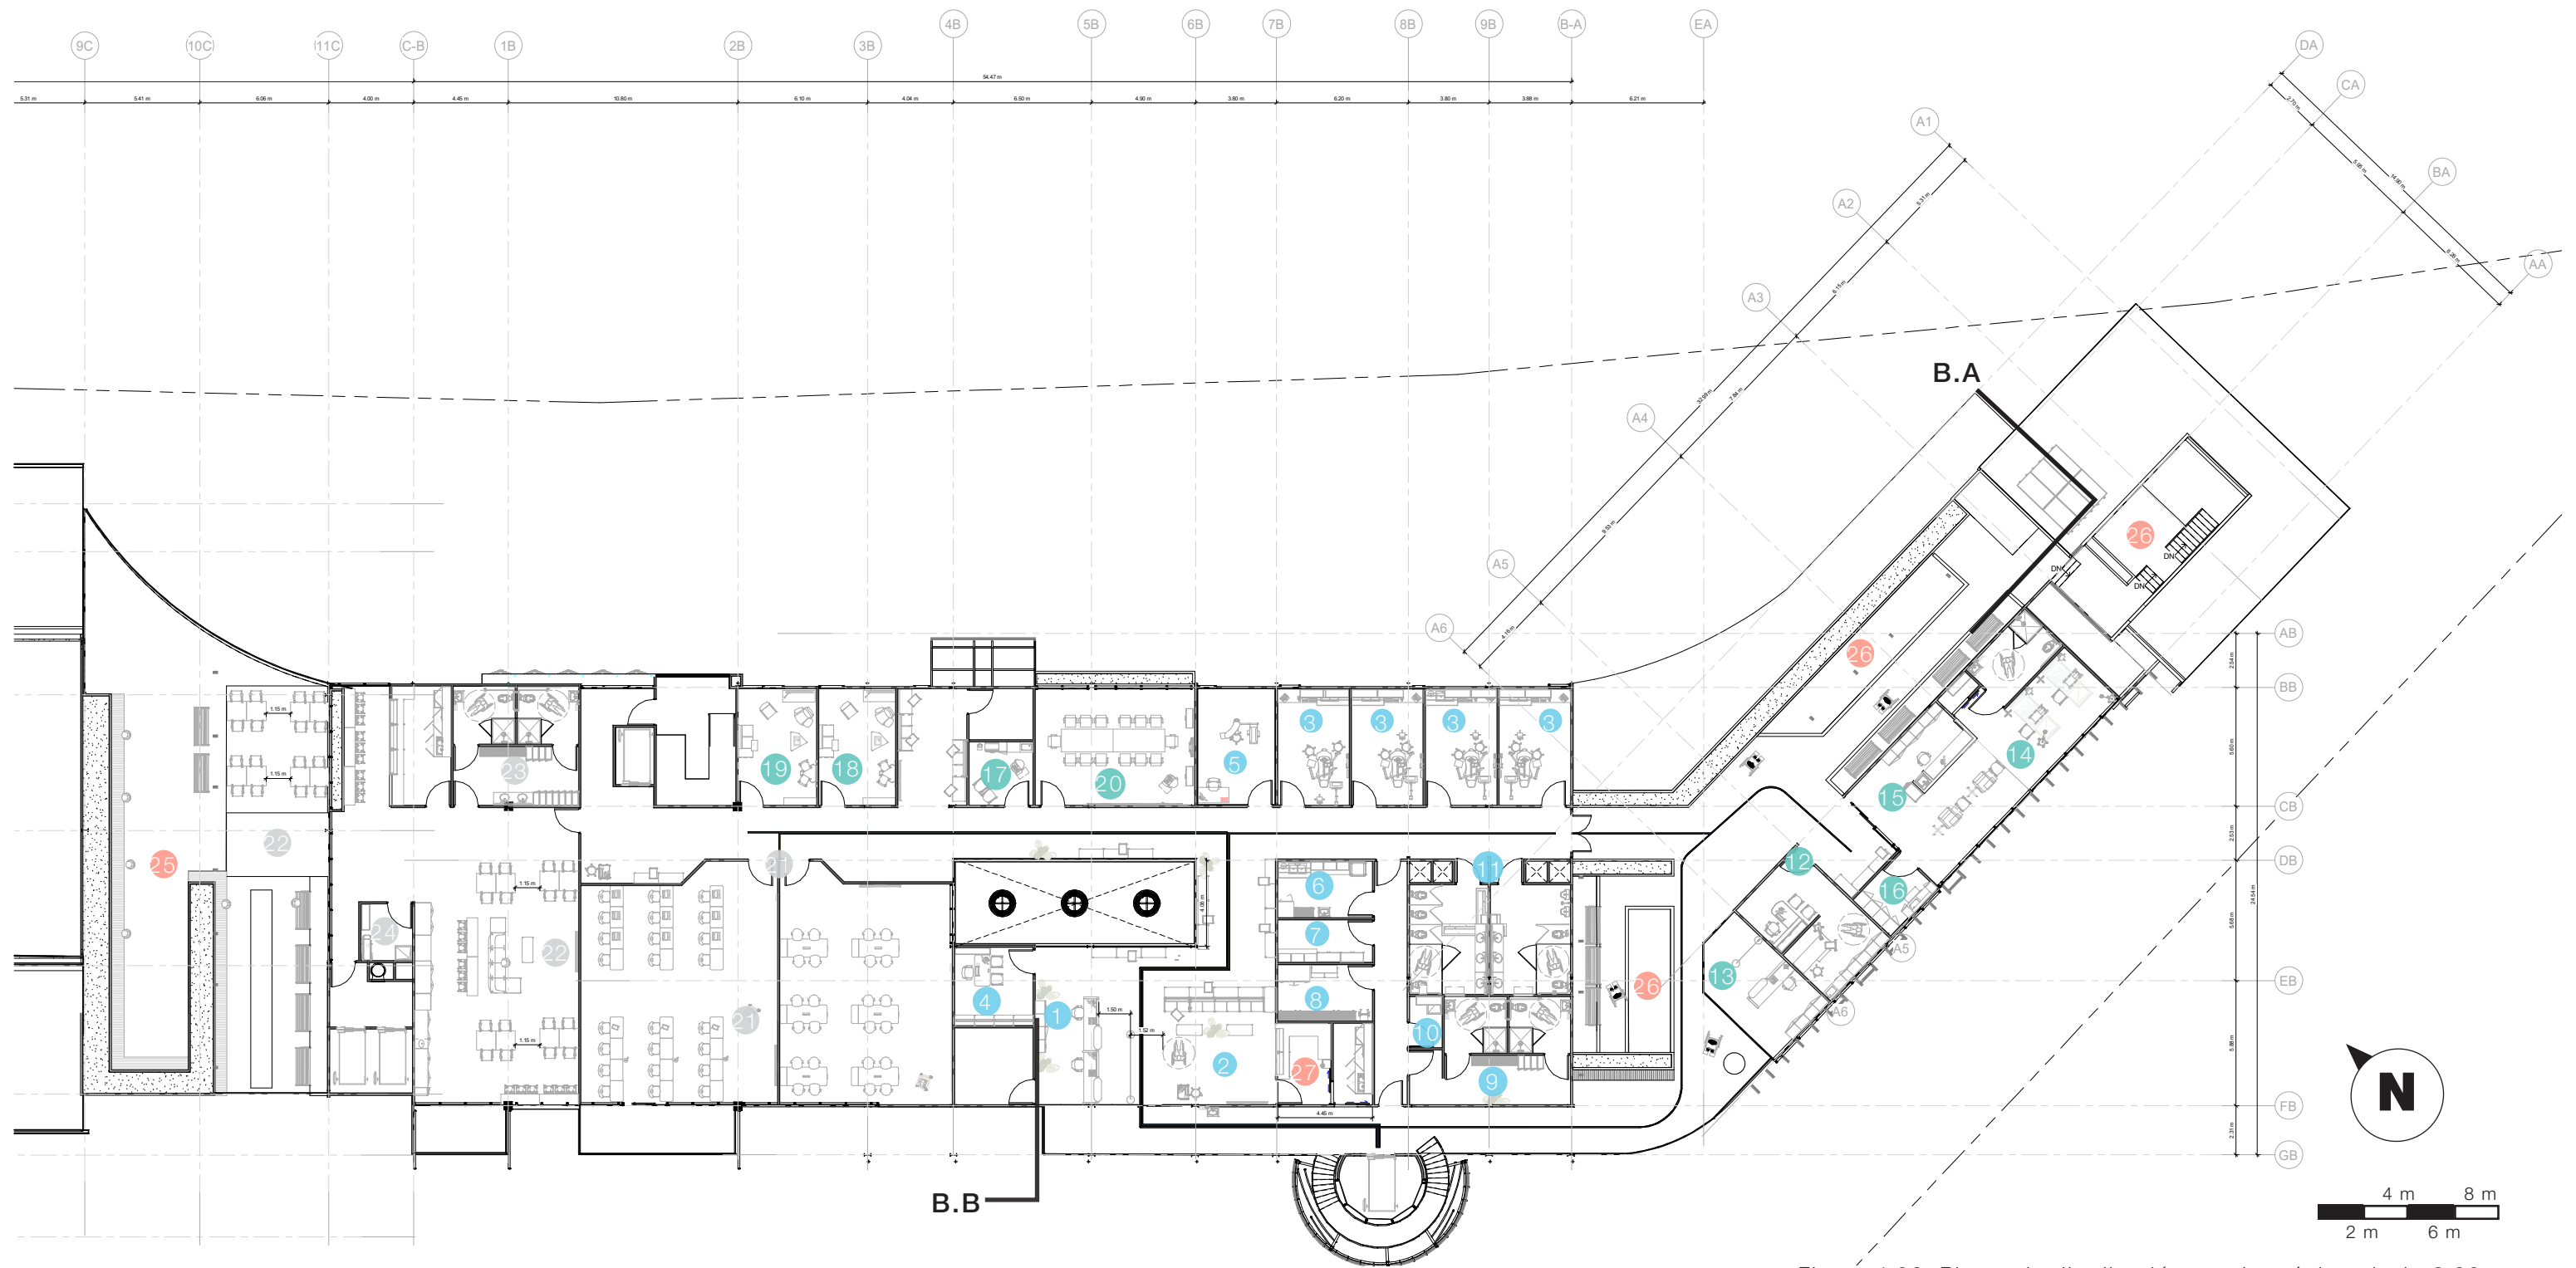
Planta de distribución arquitectónica nivel +8.00 m
